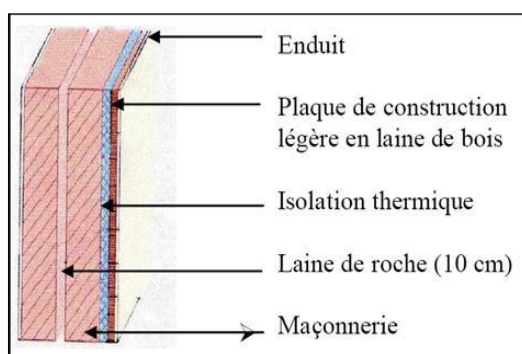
Détail des murs Isolants extérieurs Source : [www.eti-construction.fr](http://www.eti-construction.fr)
